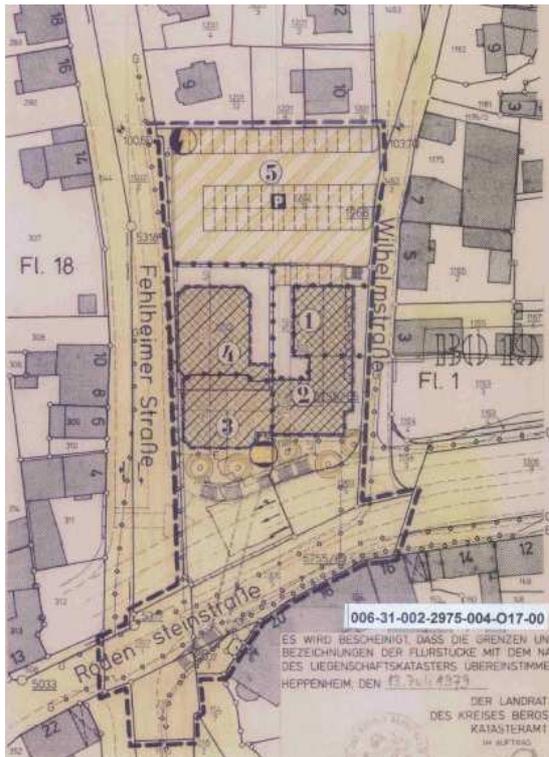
Bebauungsplan BO 17 (o.M.)
